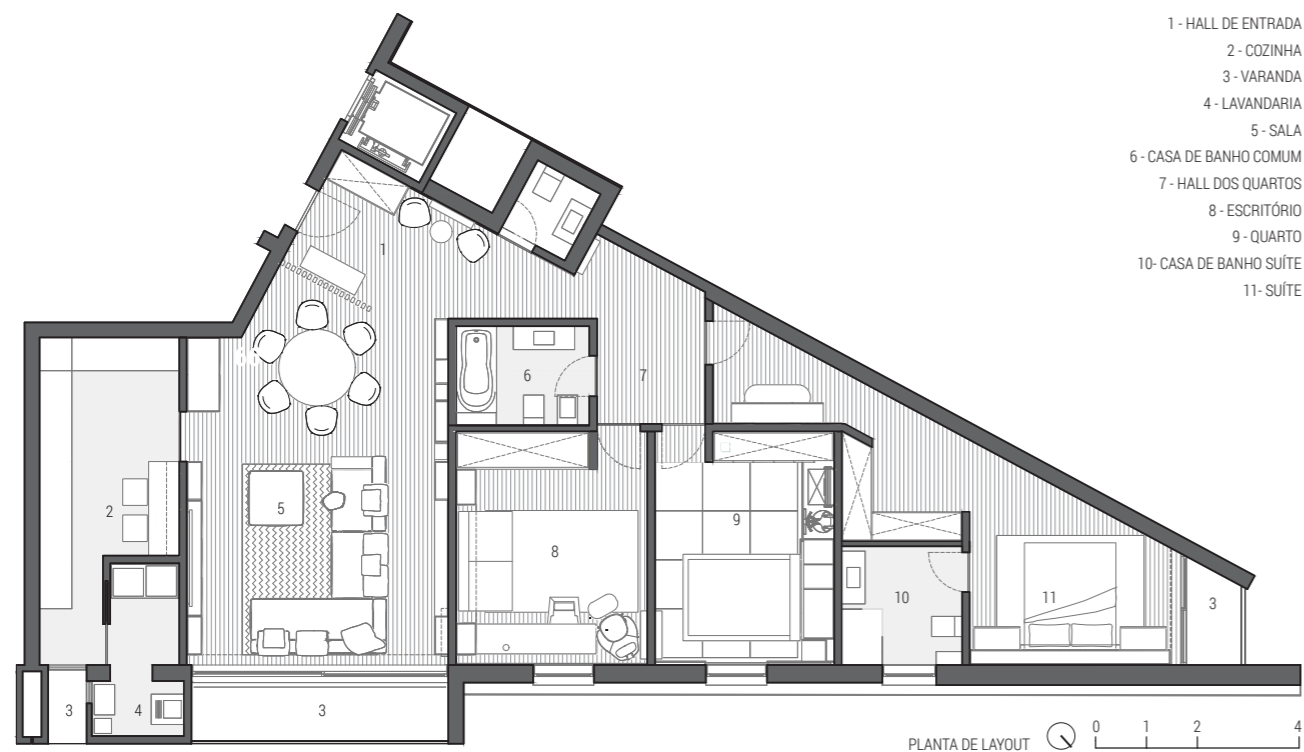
Planta de Layout, do Apartamento Um Lugar Comum*.
